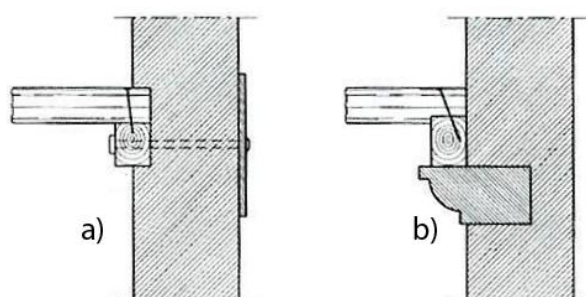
Frechais – representação esquemática: a) Encastrado na parede mestra e fixo por ferrolho; b) apoiado em cachorros de cantaria [52]
